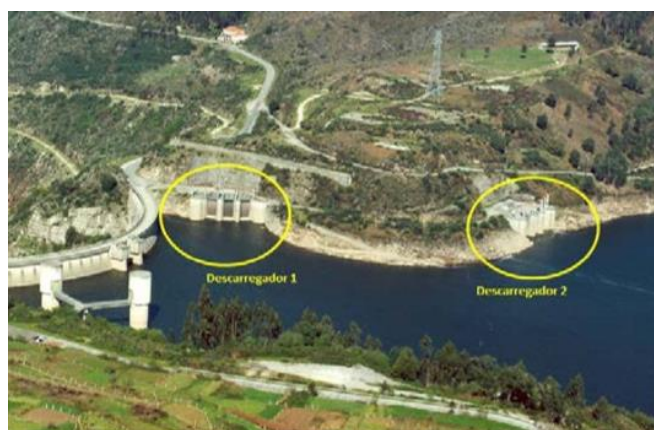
Vista das estruturas de entrada dos descarregadores de cheia da barragem do Alto Lindoso.
